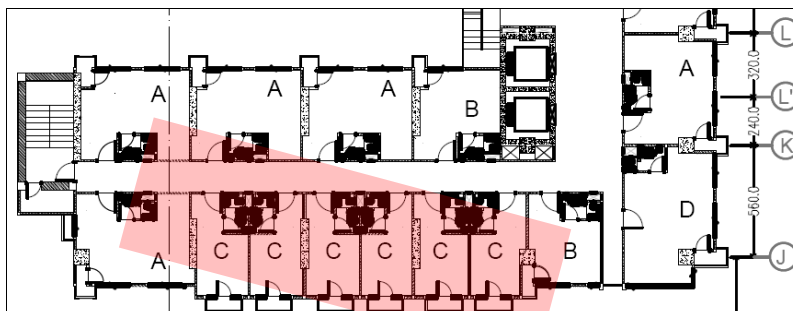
Denah Basement 1 Apartemen TJ (Sumber: Pensil Desain Drawing, diolah)
